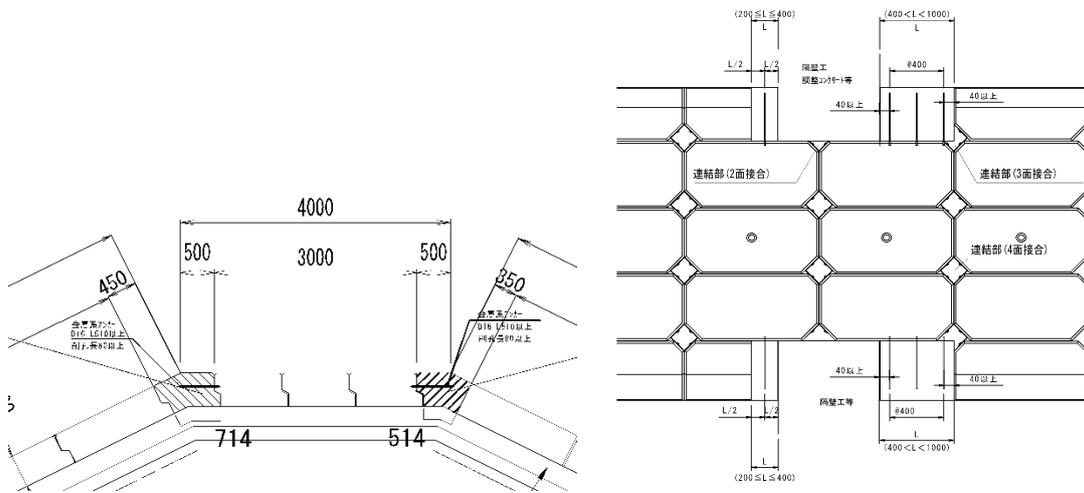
天端被覆コンクリート標準断面 (天端二次製品)
